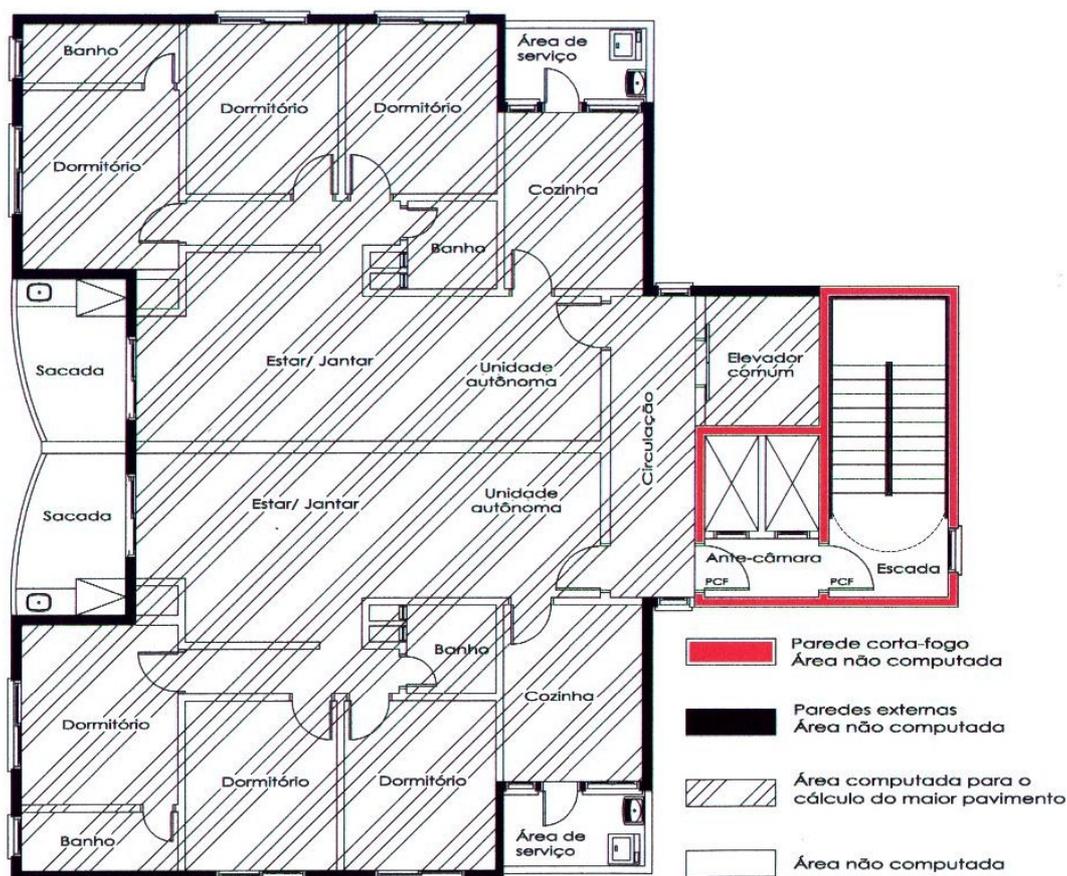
Para o cálculo da área do maior pavimento, só devem ser computadas as áreas internas das paredes externas, com exceção da área das caixas de escada.
